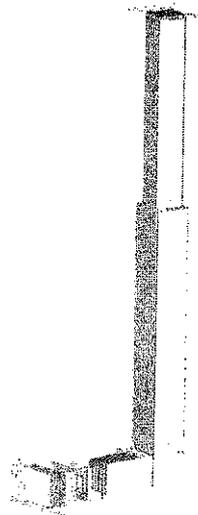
Disposition du puits Nédélec avec un rejet au niveau des toits de l'immeuble
